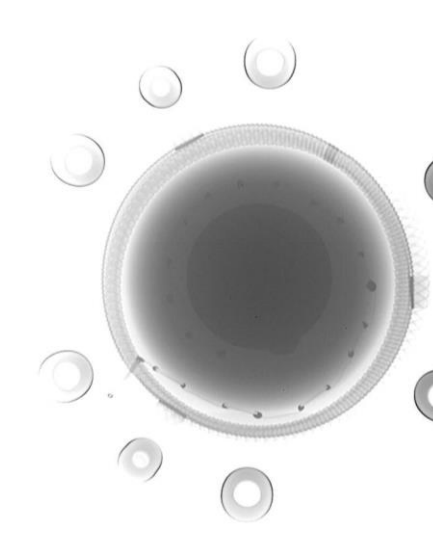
Vista em planta do perfil superior do isolador 1 em RX.
